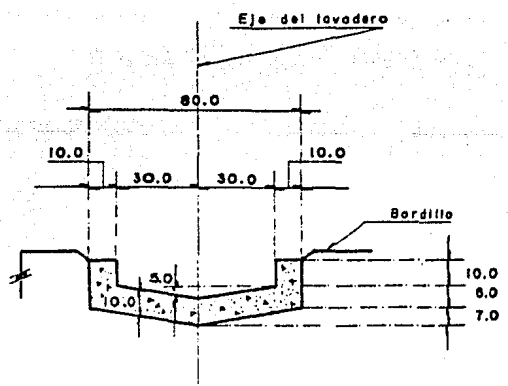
SECCION TRANSVERSAL DE UN LAVADERO
